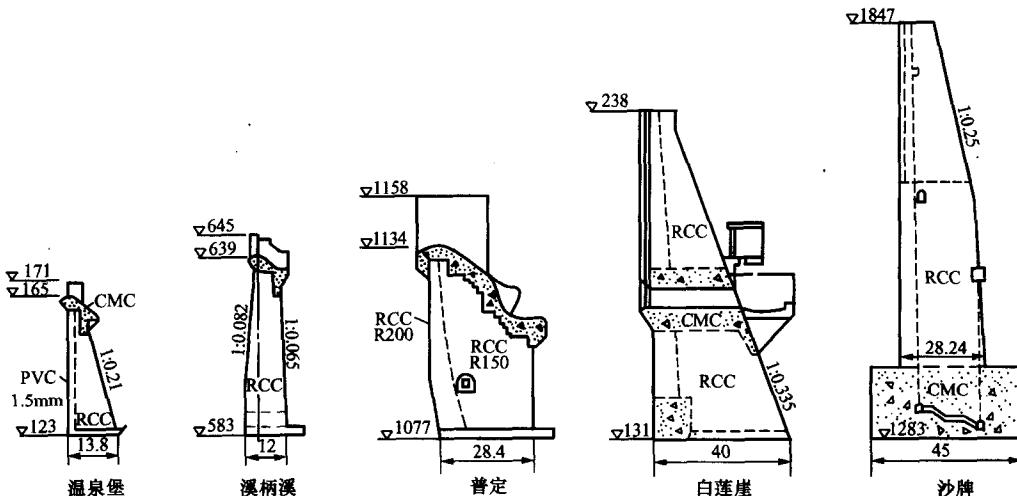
我国的几座碾压混凝土拱坝断面型式（单位：m）
